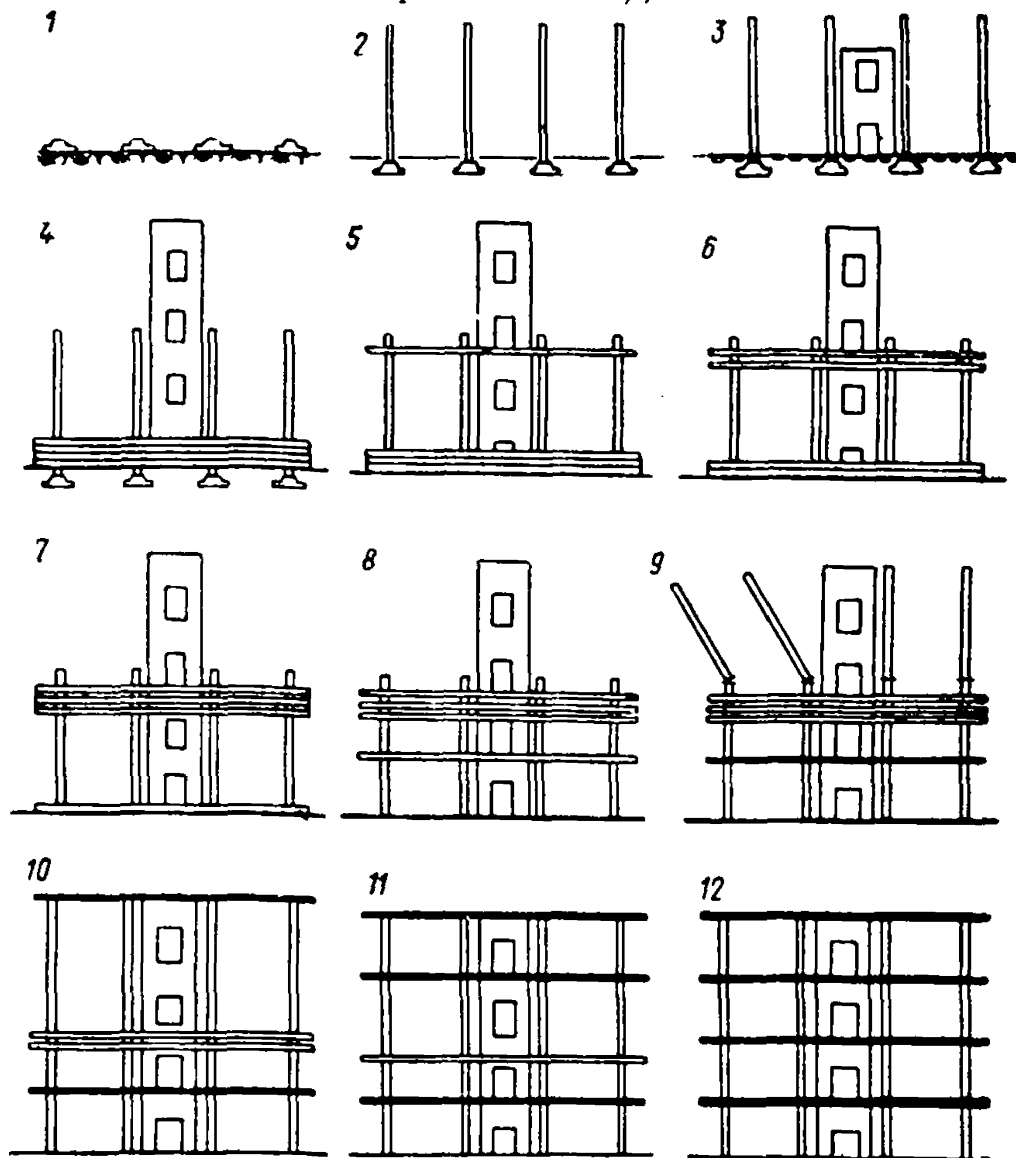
Возведение 4-этажного здания методом подъема перекрытий
